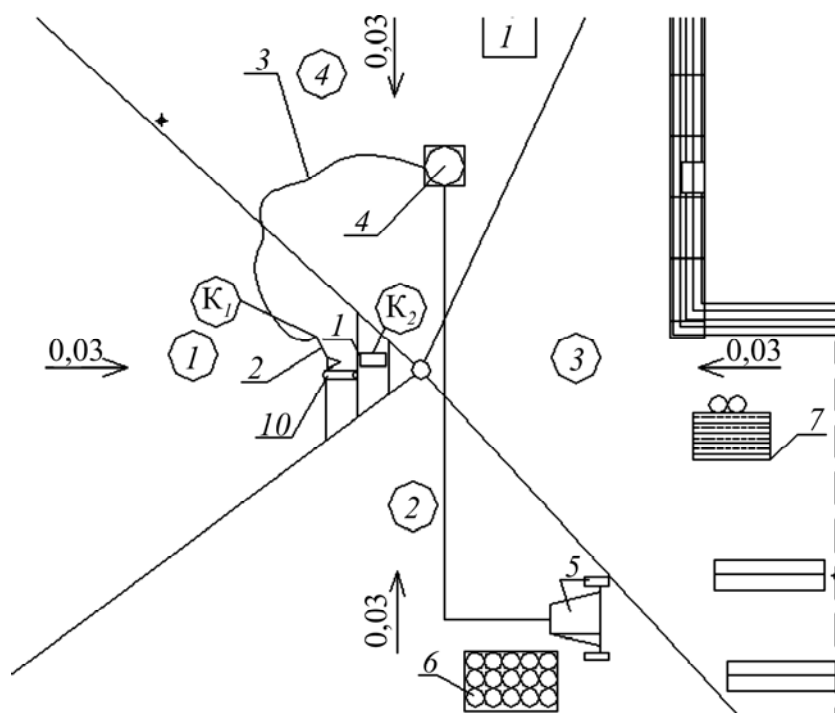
Схема организации рабочего места при работе с газовыми горелками: 1 — каток ручной ИР-735; 2 — ручная горелка; 3 — газовый рукав; 4 — стойка с газовым баллоном; 5 — ручная тележка; 6 — контейнер; 7 — ящик с песком и огнетушители
